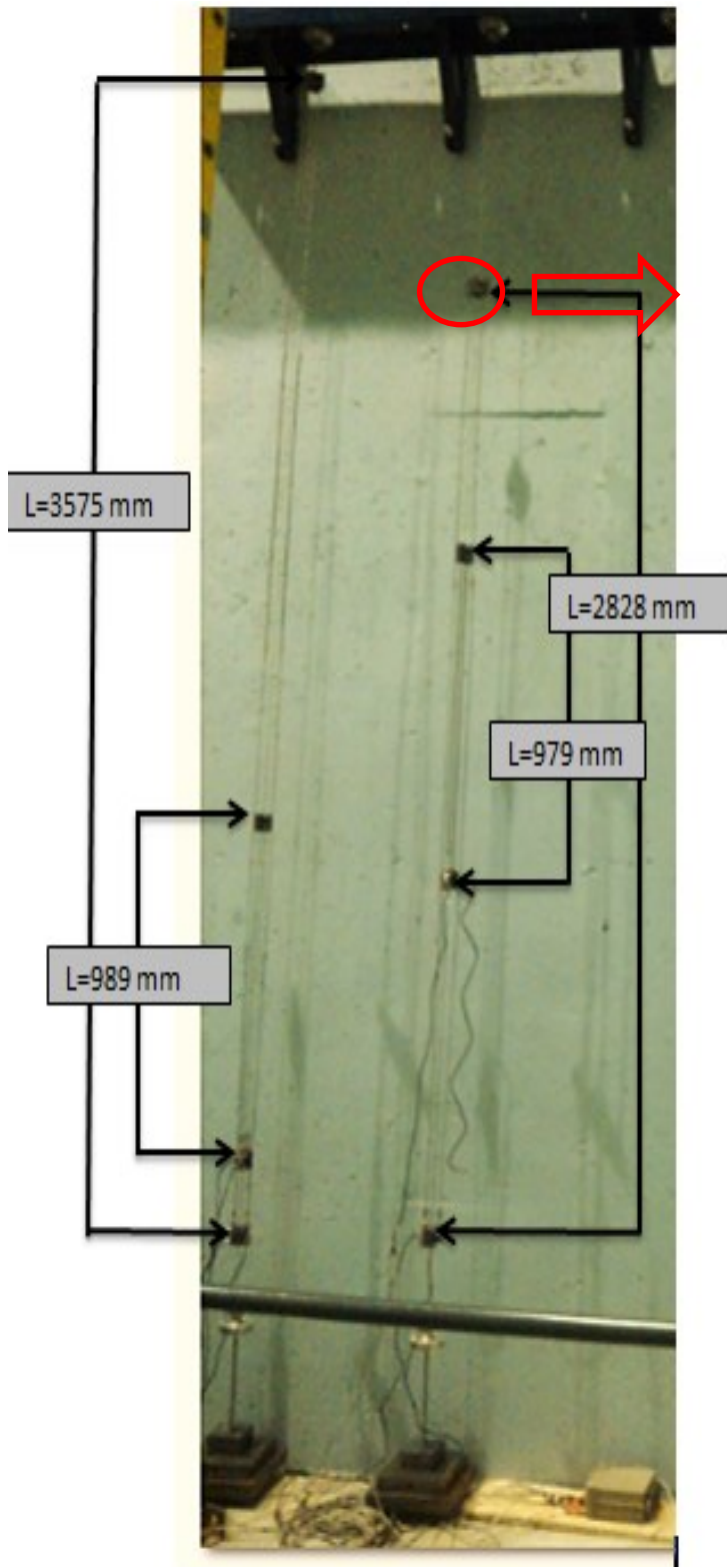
Série 3 - essais préliminaires sur différentes longueurs
